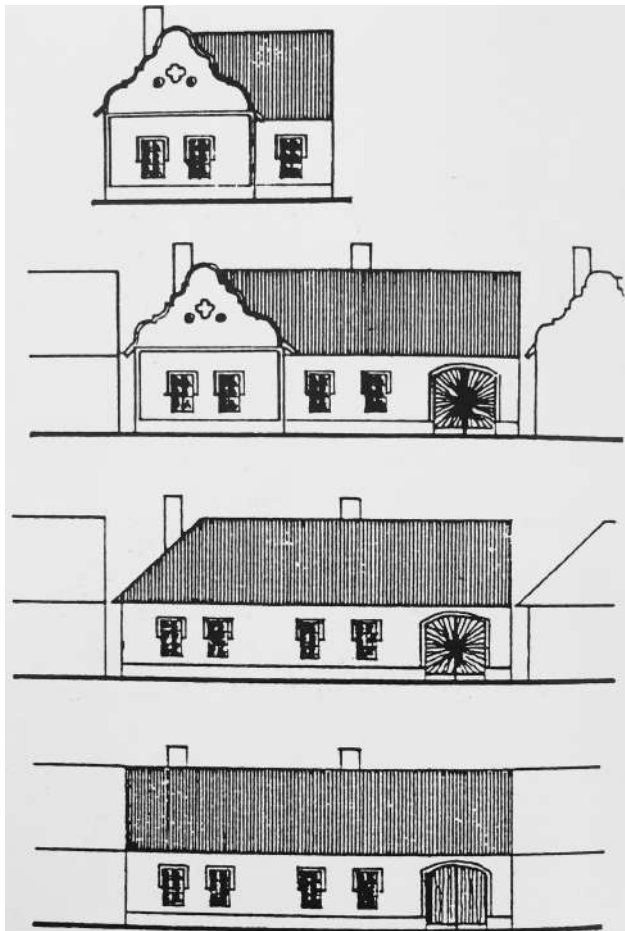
Fassadenentwicklung: Übergang vom Giebel- zum Traufenhaus, Breitfassadenhaus ohne Giebel, Breitfassadenhaus mit anschließendem Satteldach
